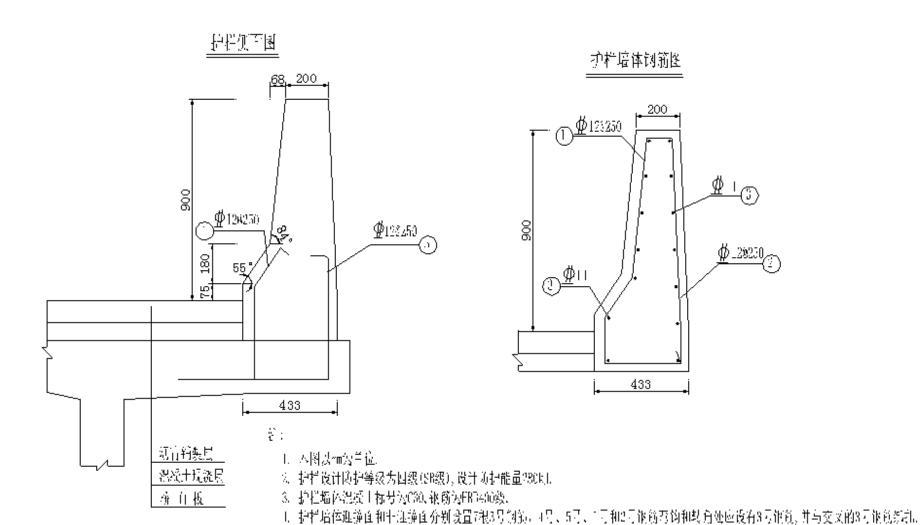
四(SB)级 F 型桥梁混凝土护栏设计示例(尺寸单位: mm)
